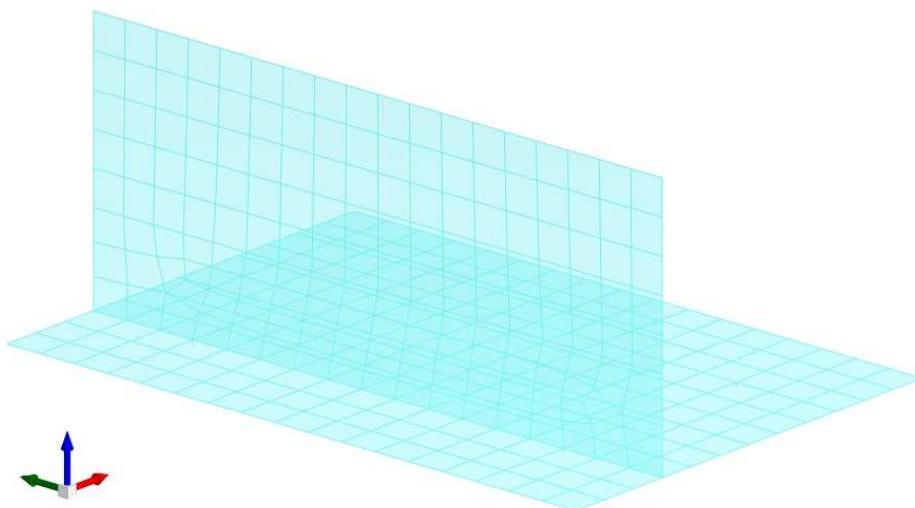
Modello con platea - Vista tridimensionale fronte - Spalla tipo
